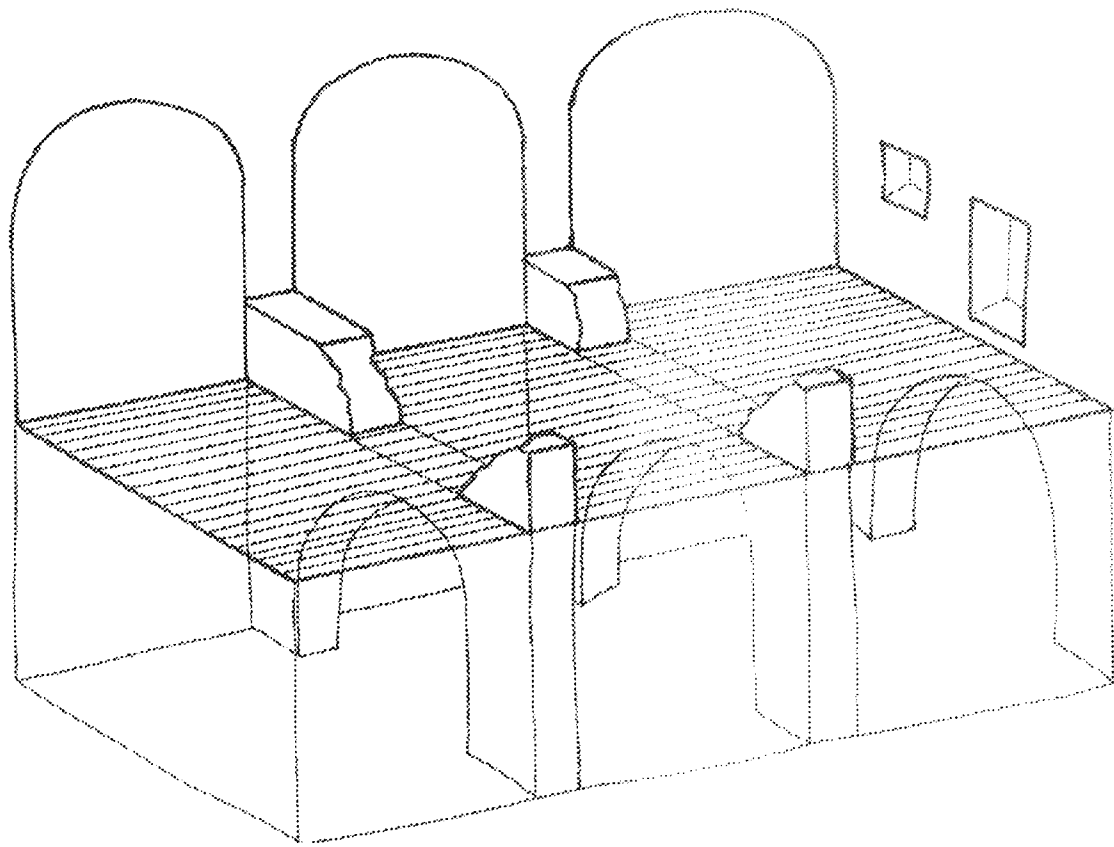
Croquis – Perspectiva de la punta SW, planta subterània.
